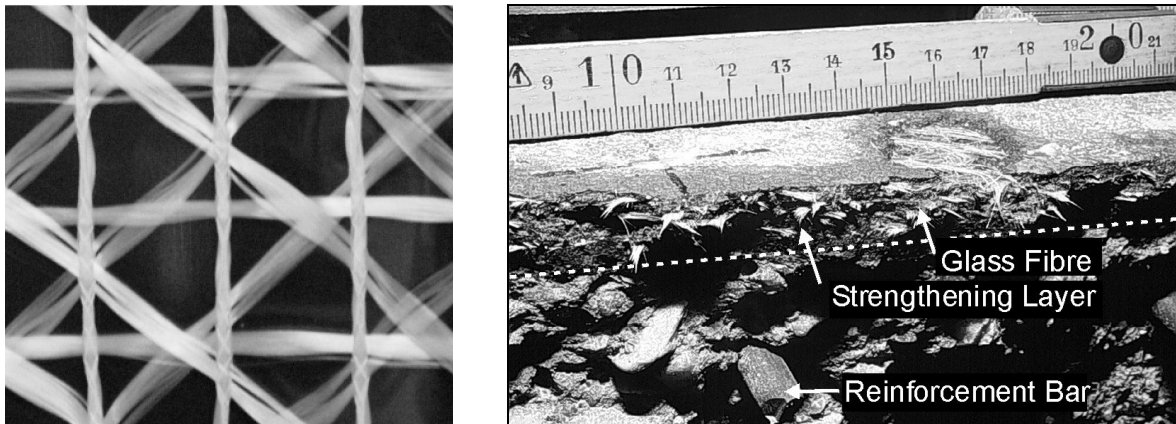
Textilbewehrung links und textilbewehrte Betonschicht auf einer verstärkten Platte nach einem Biegeversuch (rechts)
